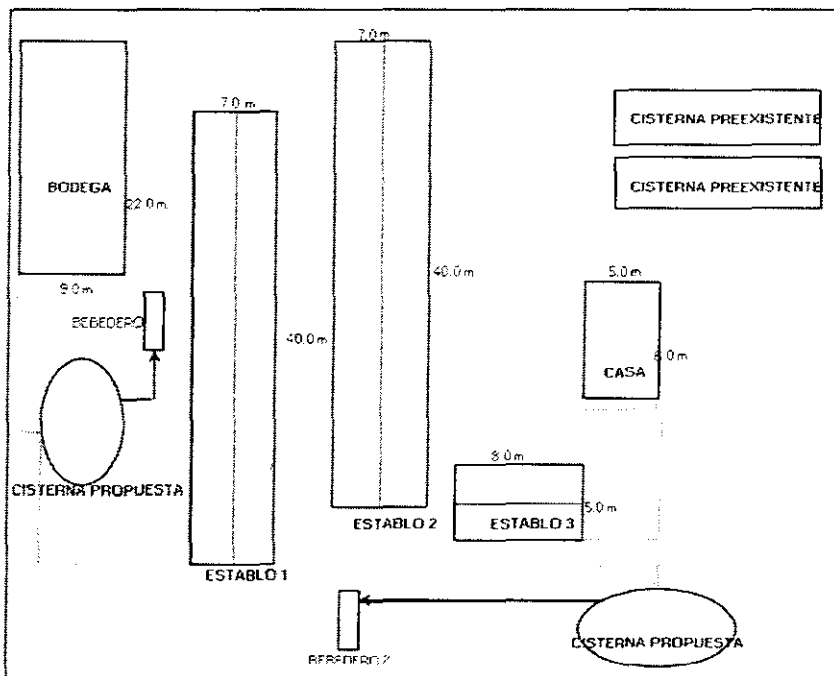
Croquis de infraestructura en el rancho que muestra el área de captación
